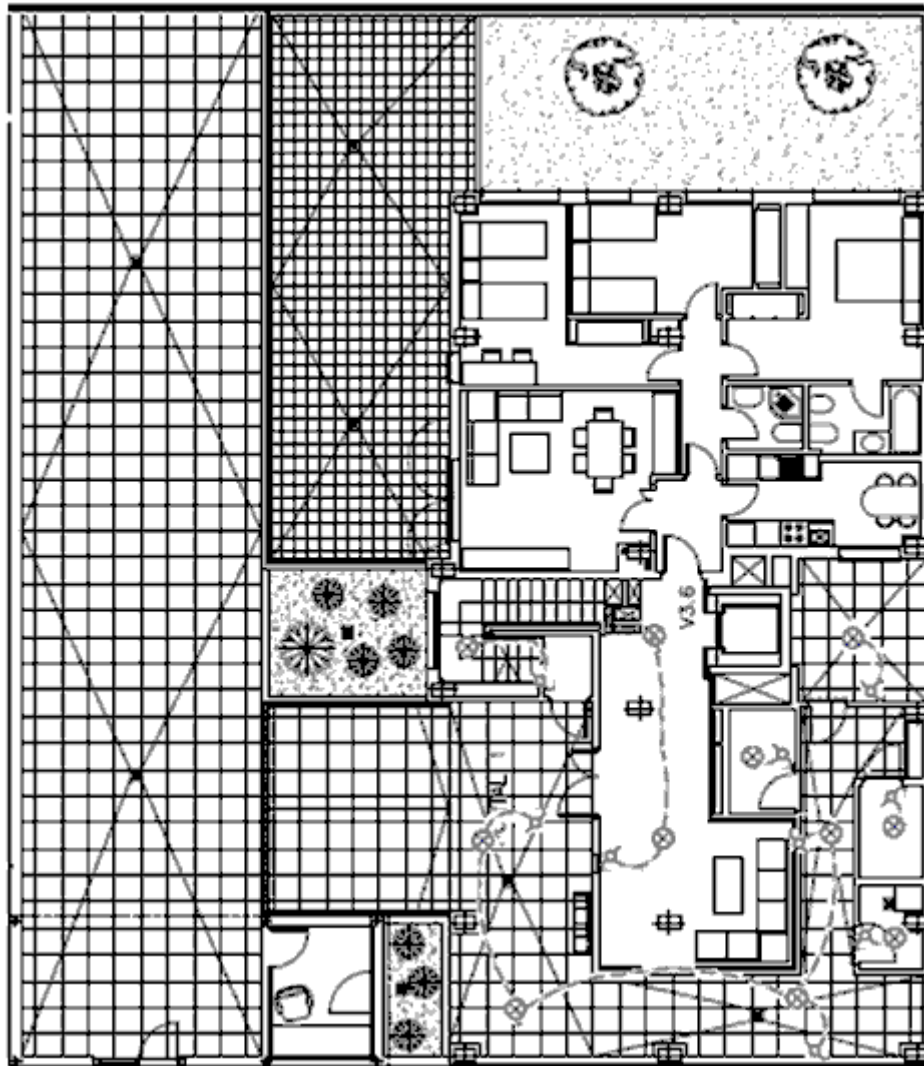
Planta baja del edificio con iluminación en las zonas comunes (Zona común)
